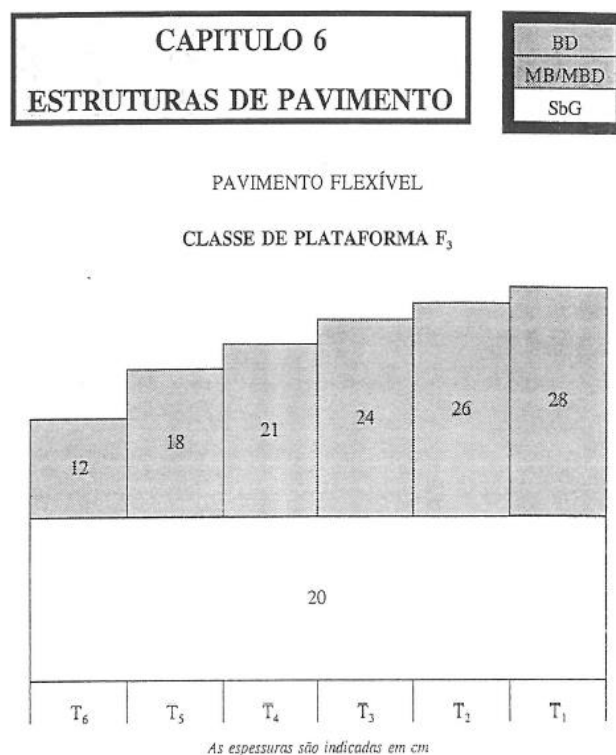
Estrutura tipo para pavimento flexível proposta pelo MADIPAV para o pré-dimensionamento da espessura das misturas betuminosas e dos materiais granulares (EP-JAE, 1995)
